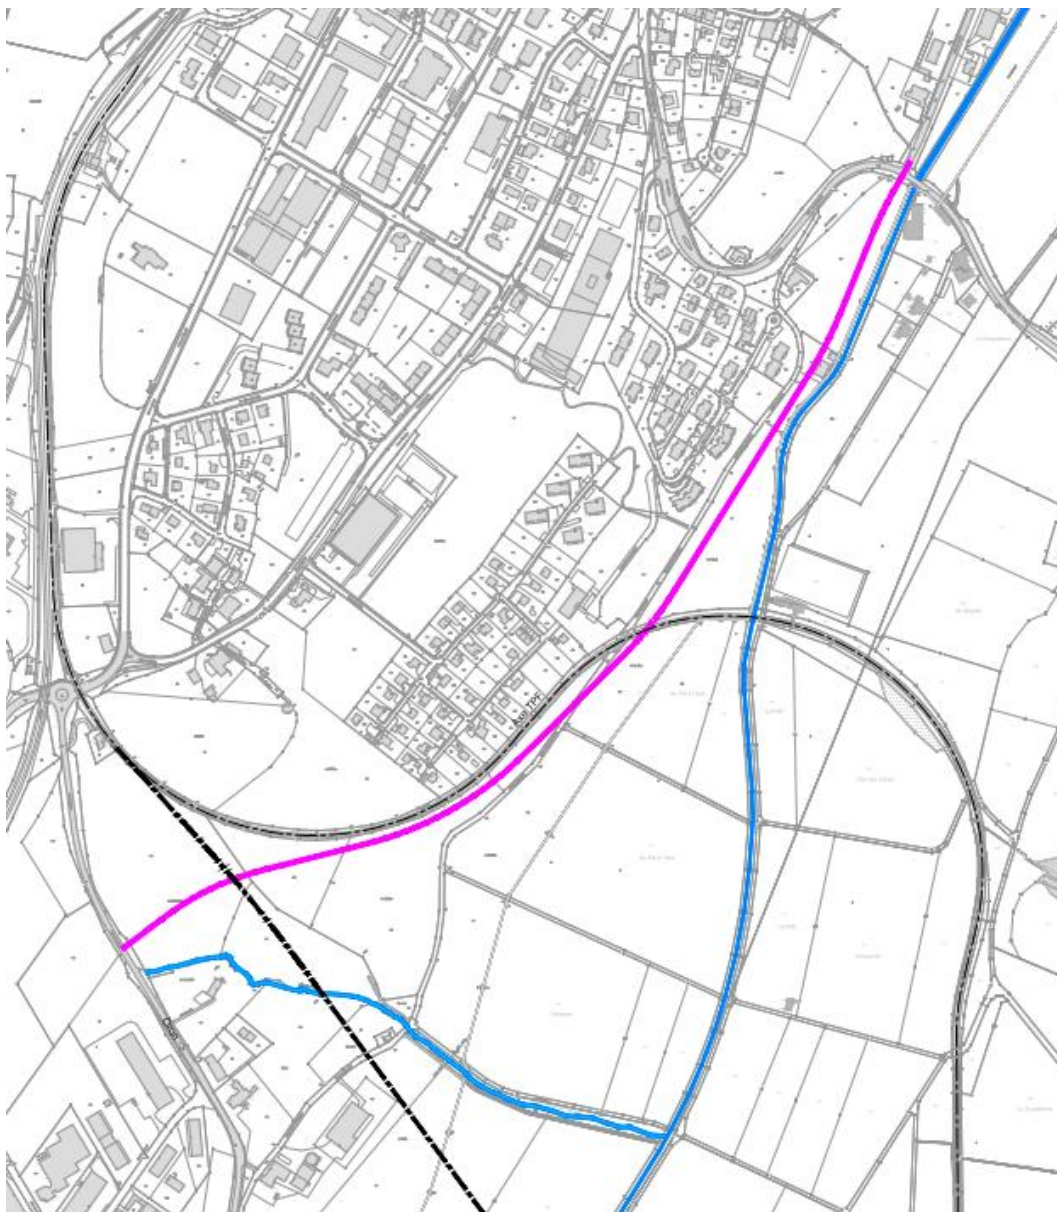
Plan du tronçon Sud Variante 2 - Route de la Parqueterie à Route de Lausanne
